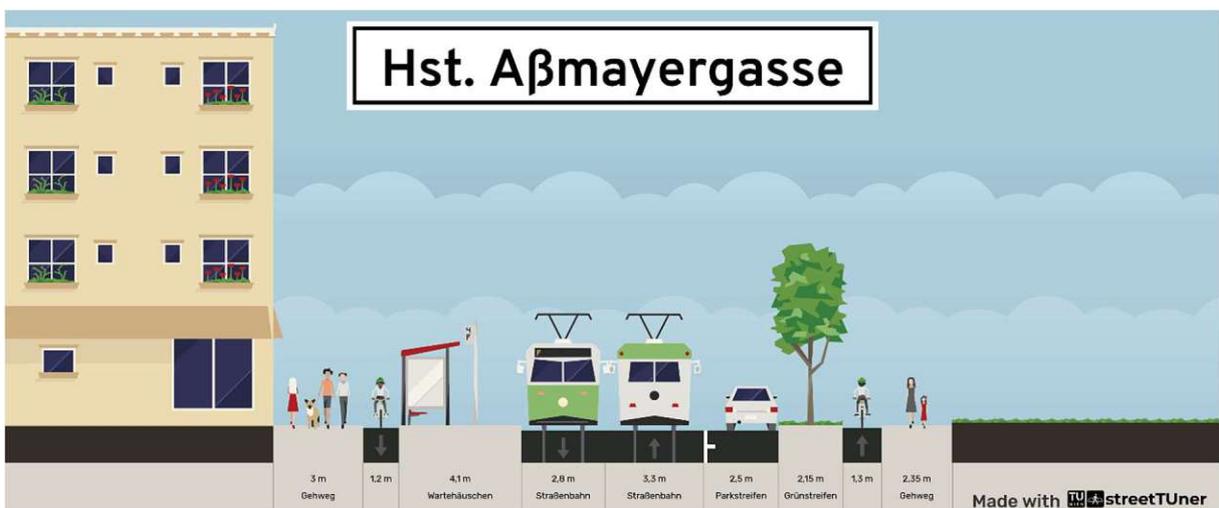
Querschnitt Haltestelle Aßmayergasse. Quelle: TU Wien – StreetTuner (streettuner.fvv.tuwien.ac.at)
